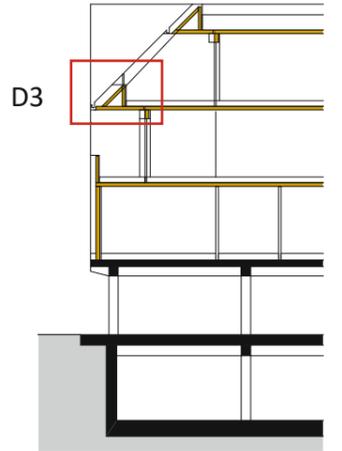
ANSCHLUSS DACH / AUSSENWAND / TERRASSE
